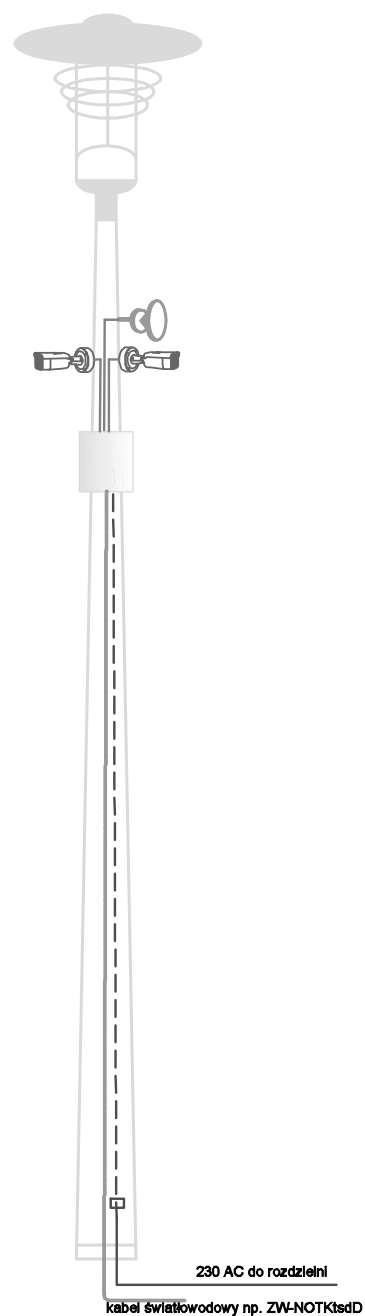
Plan poglądowy rozmieszczenia urządzeń systemu monitoringu wizyjnego - Amfiteatr
